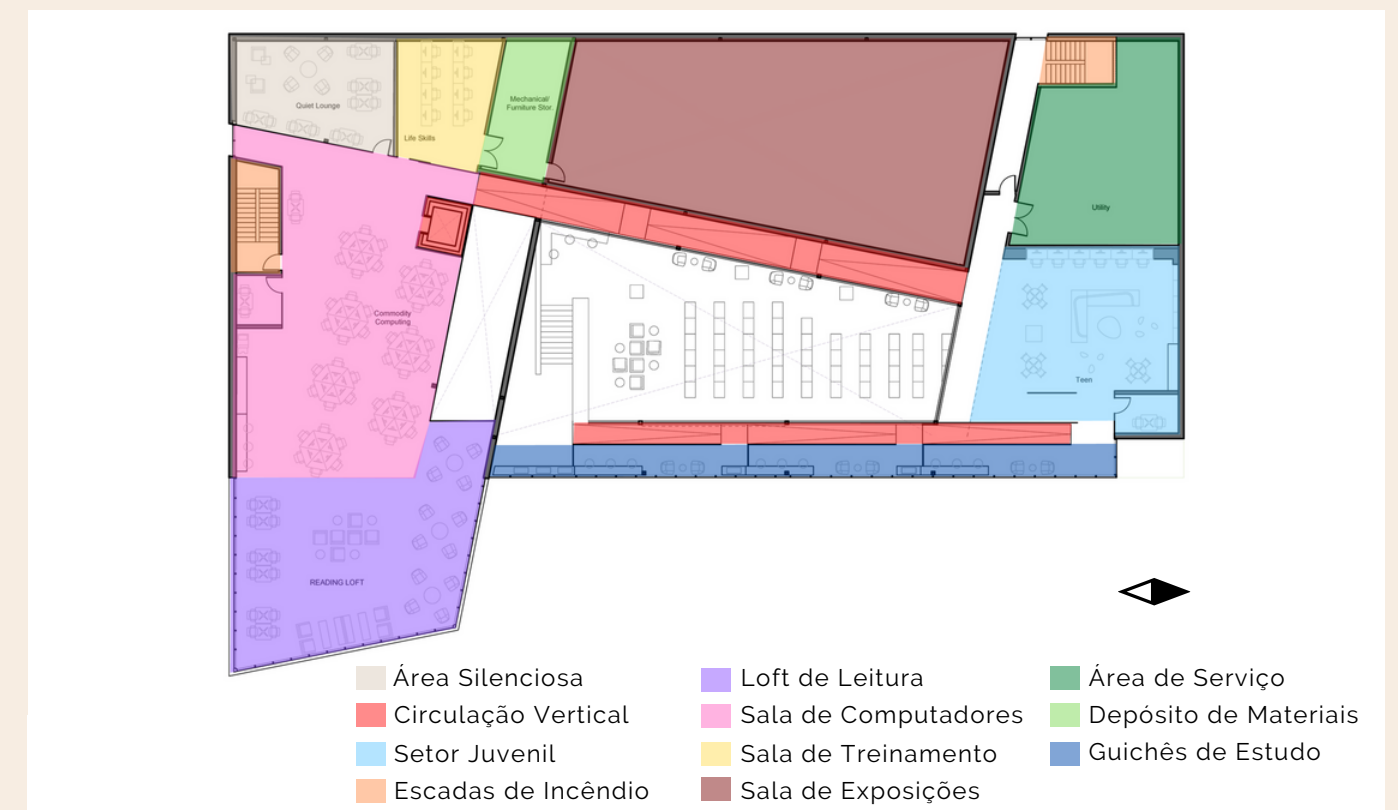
Setorização do Primeiro Pavimento da Biblioteca Northside.
